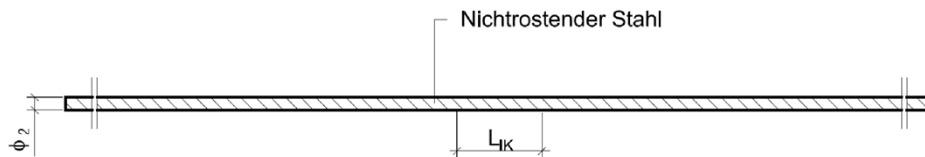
Druckelement aus nichtrostendem Betonstahl
